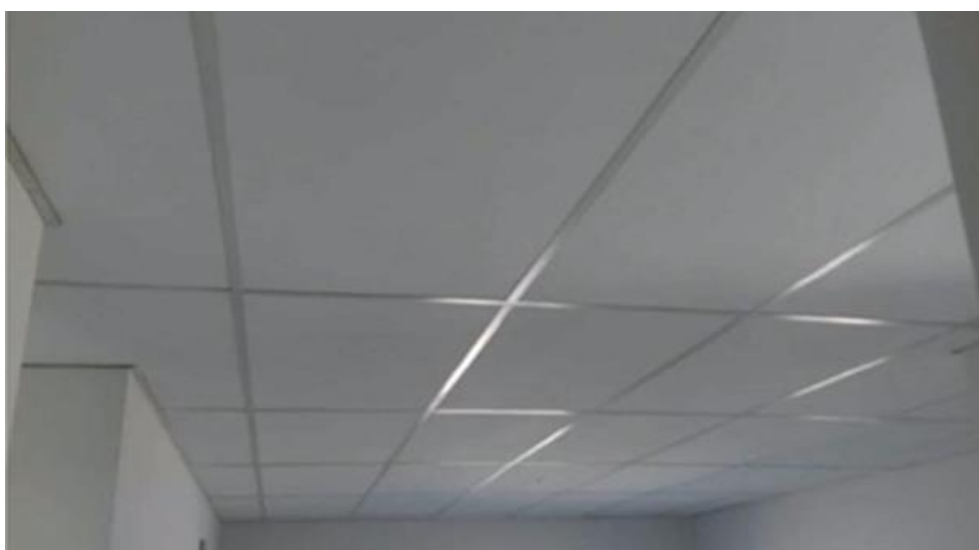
58 viviendas apareadas en Cipoletti, Gral Roca – Terminaciones (Plan 2552)
